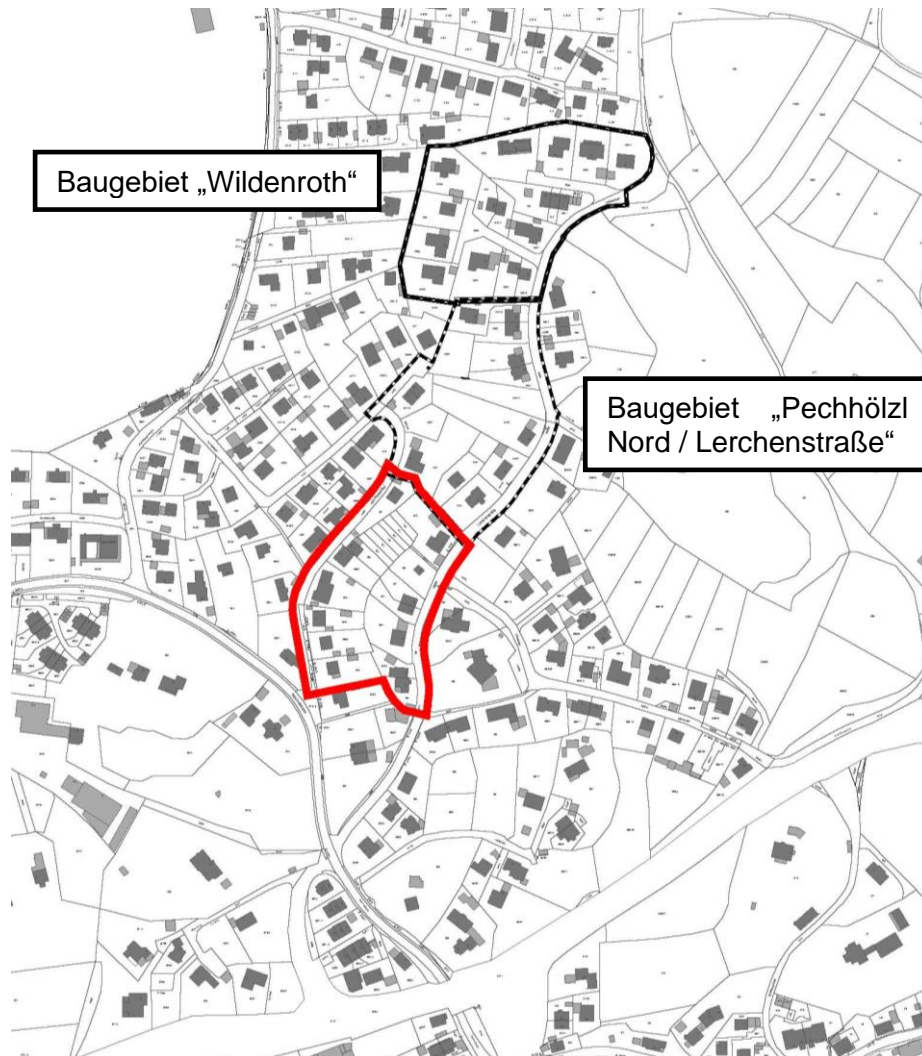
Lageplan mit Kennzeichnung geplantes Baugebiet (rot) und benachbarte Baugebiete (schwarz); Geobasisdaten © Bayer. Vermessungsverwaltung 04/2020
